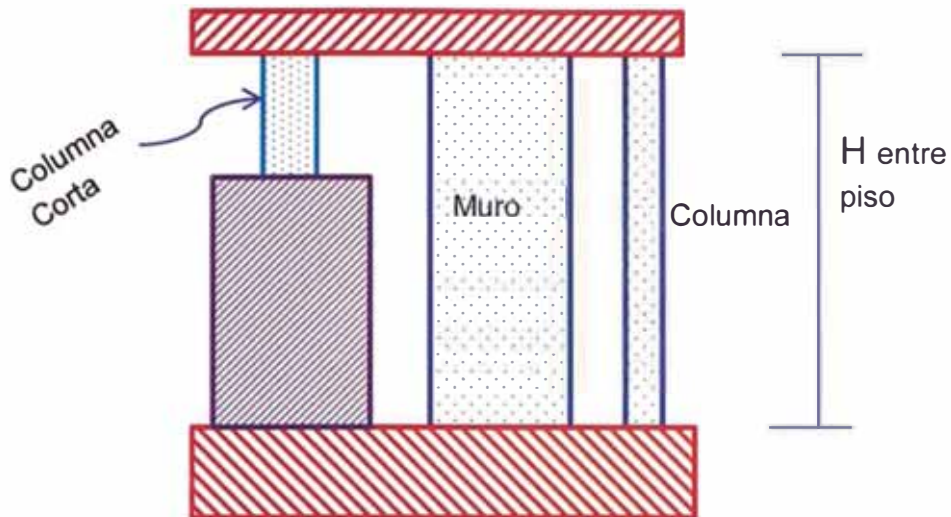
Idealización de elementos estructurales verticales del piso en análisis.
